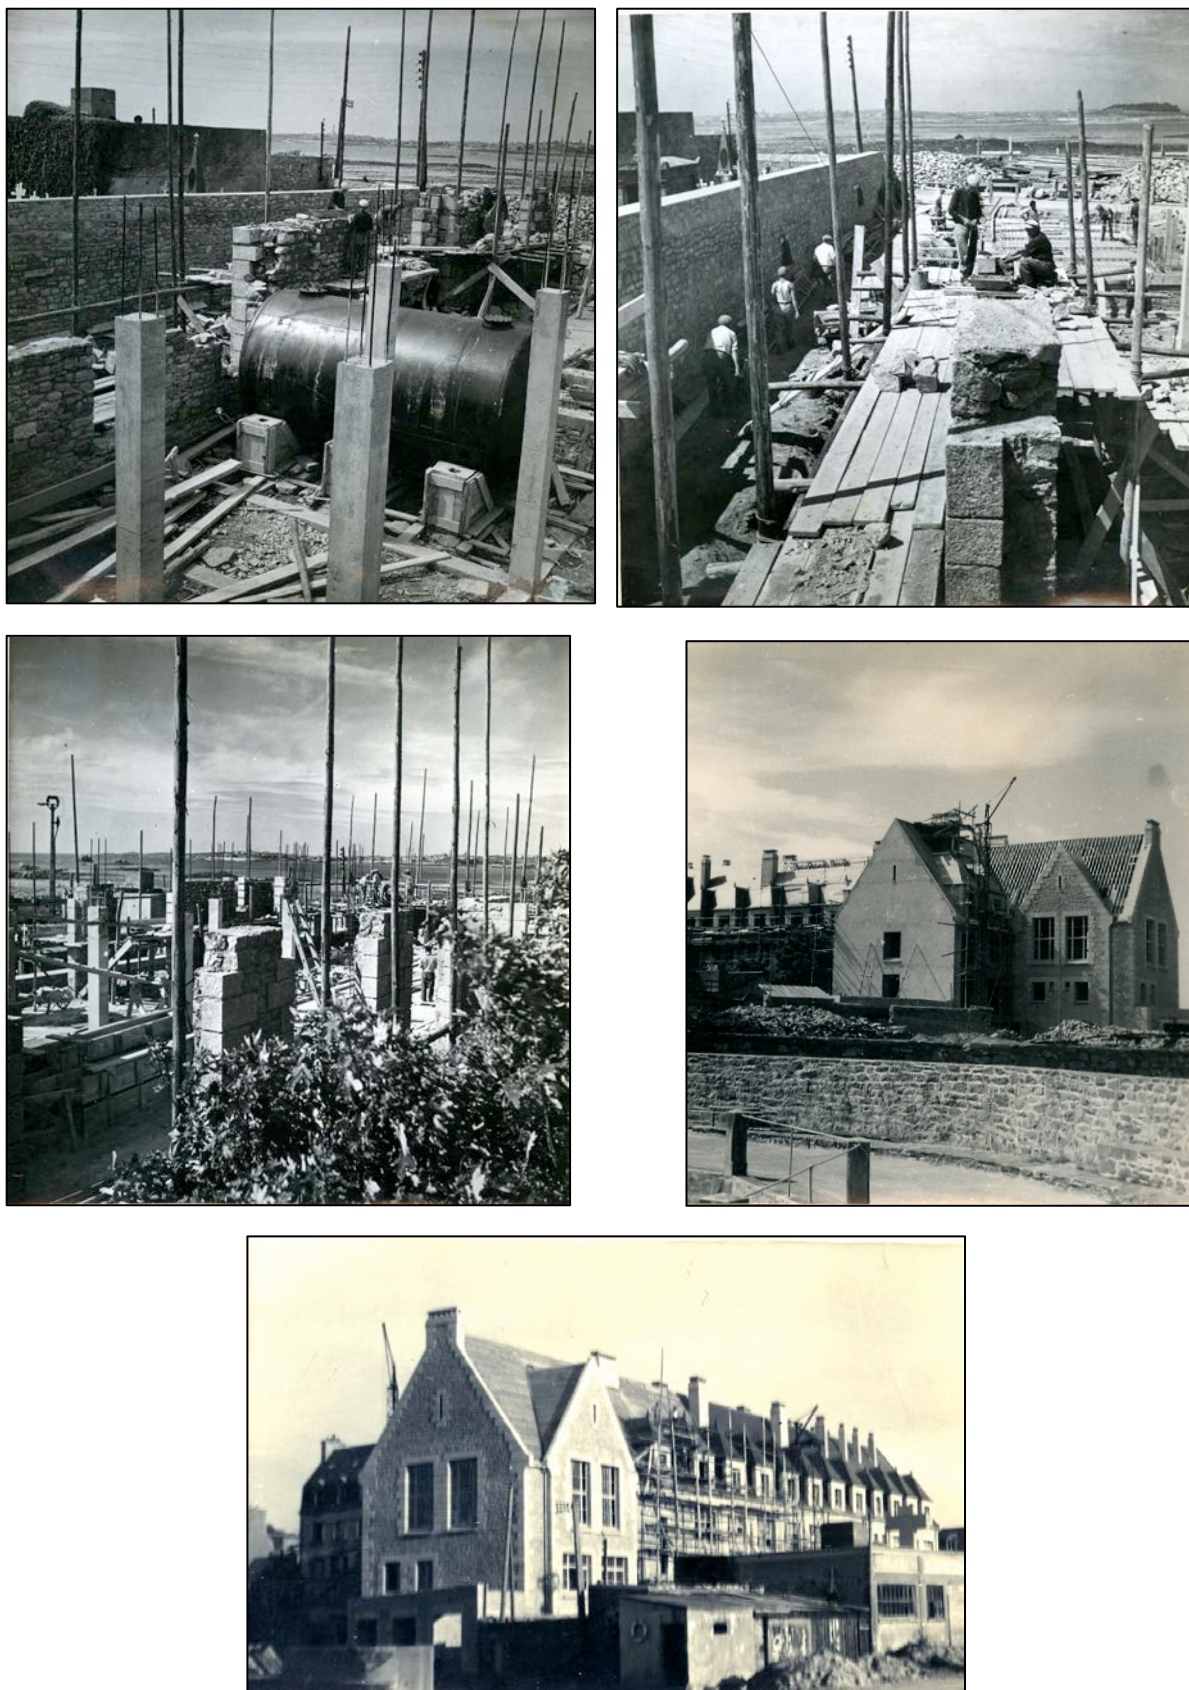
Images de la construction du Bâtiment Yves-Delage, débutée en 1949 pour une mise en service en 1953. Sous-sol et mise en place de la cuve à fuel, plancher et élévation du rez-de-chaussé, fin des travaux face Est et face Ouest. Edifier un bâtiment de cette importance et de cette qualité quelques années après la fin de la guerre représentait une véritable gageure. Crédit : PD, CL, ASBR.
